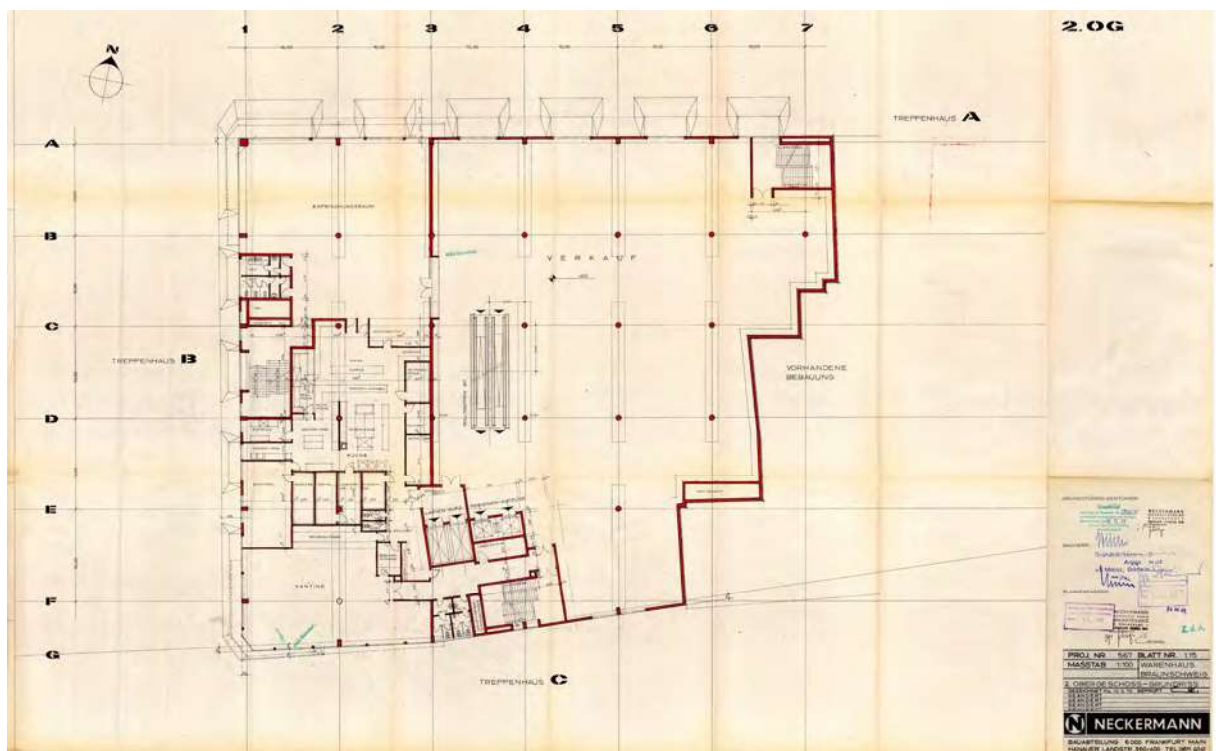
Karstadt - Grundriss 2. OG mit Restaurant
